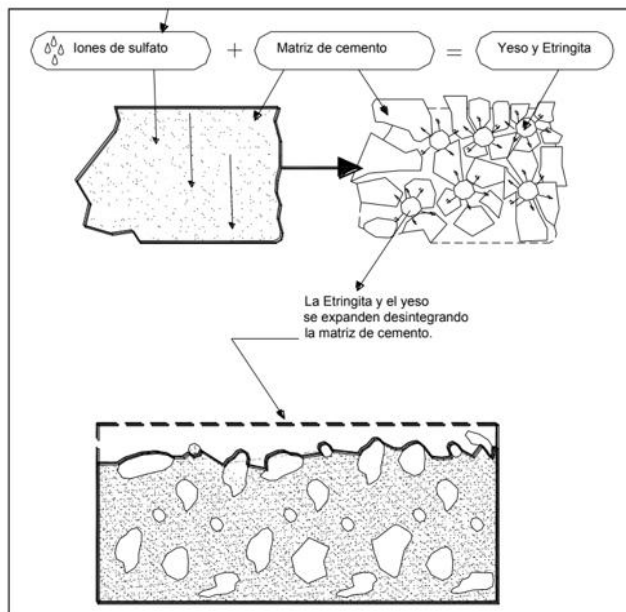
Detalle de fisuras de ataque por sulfatos 2
